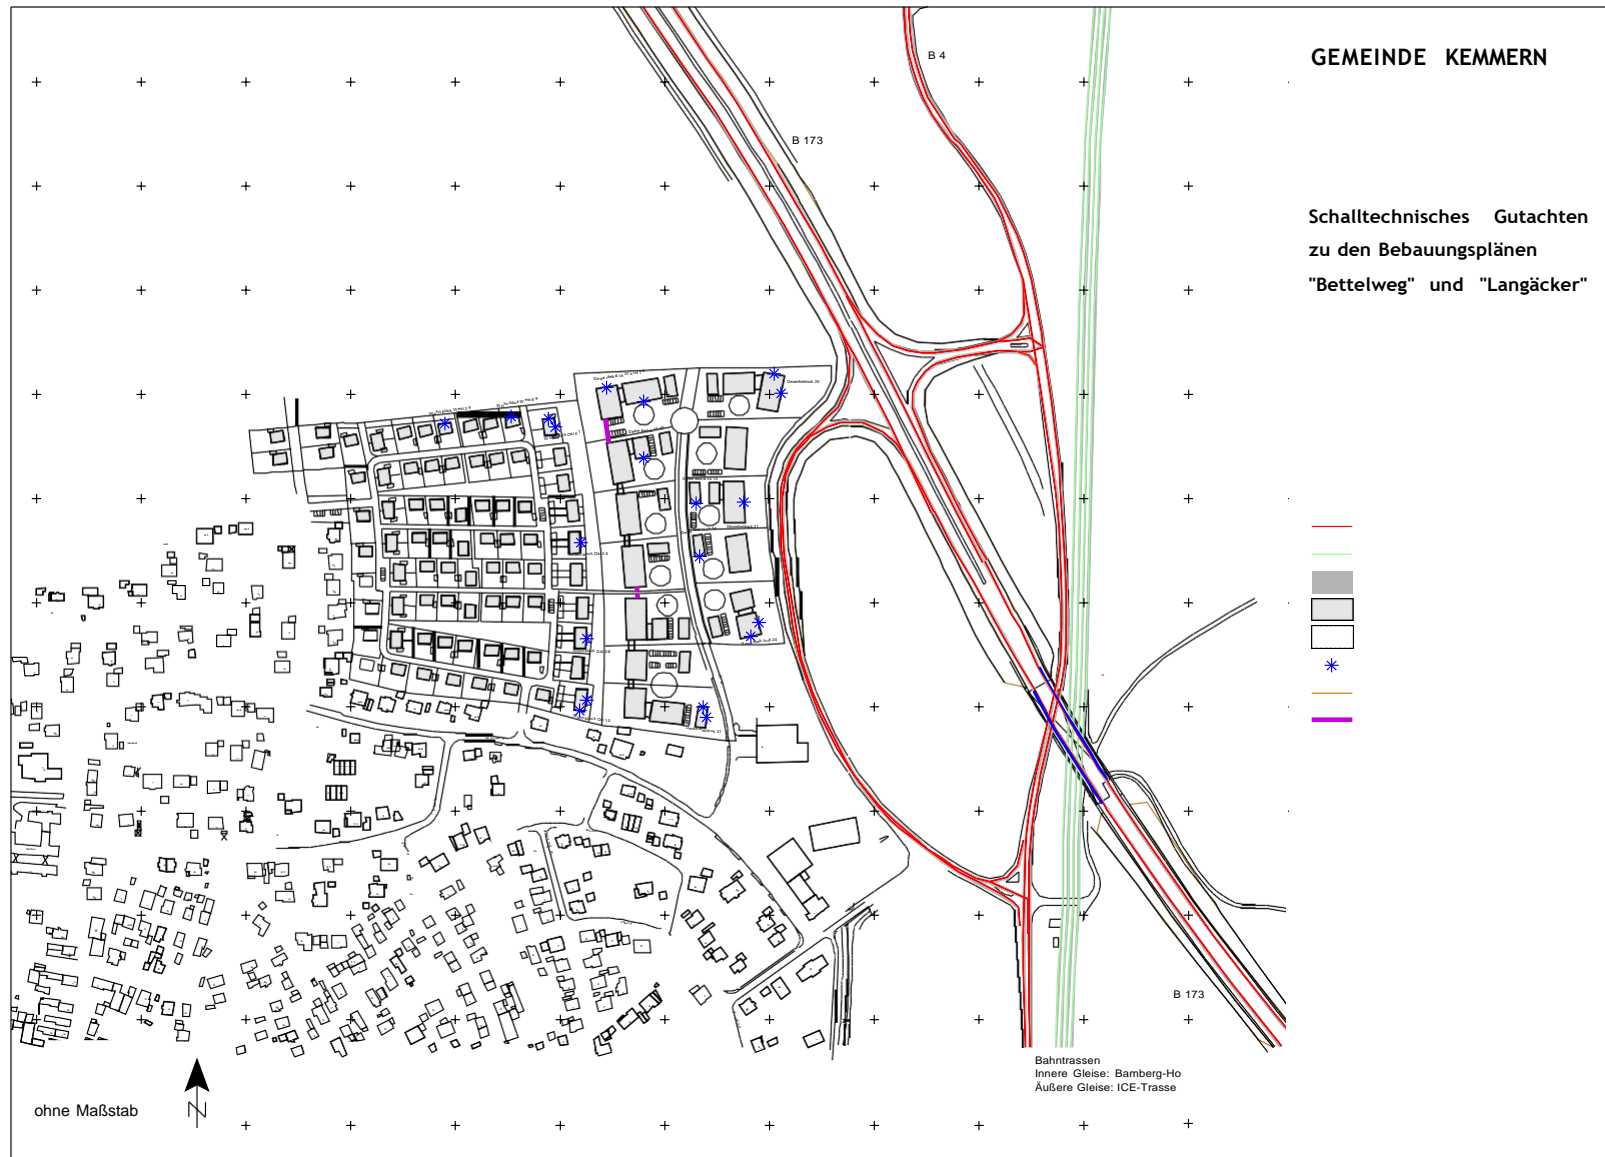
Ausschnittvergrößerung des Lageplans Bebauungspläne „Bettelweg“ und „Langäcker“
